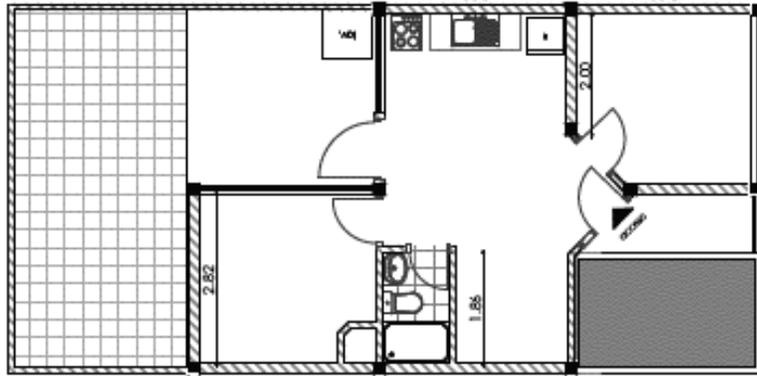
Planta arquitectónica vivienda tipo 1 en urbanización "Los Nogales".
